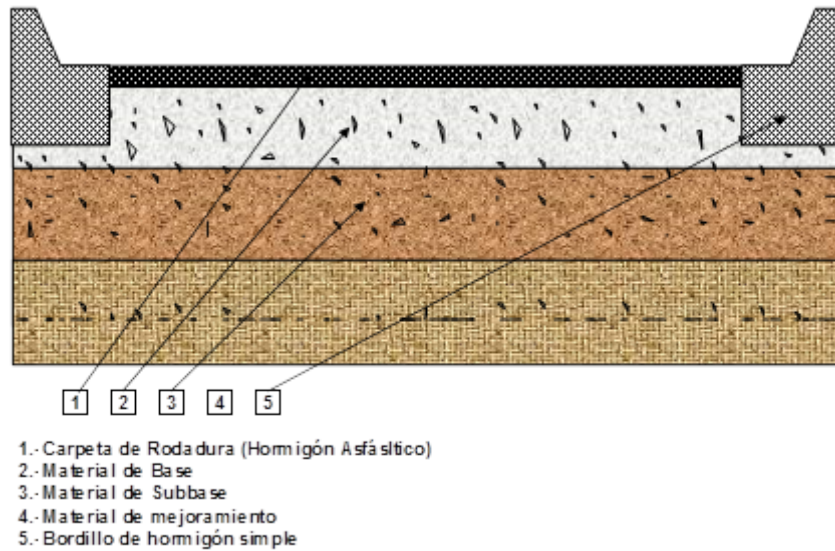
Sección Típica del Pavimento Flexible/Fuente Propia.
